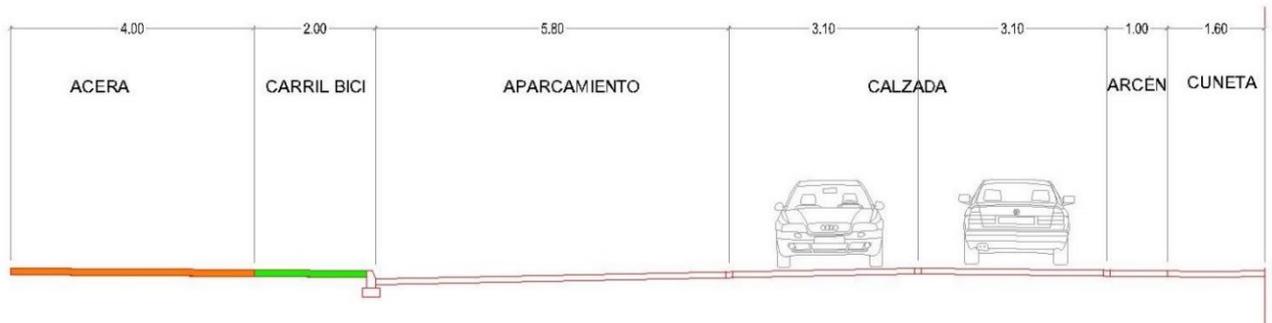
Sección carretera del Garo entre avda. Vicente Cañada Blanch y c/ Maestro Rodrigo.
